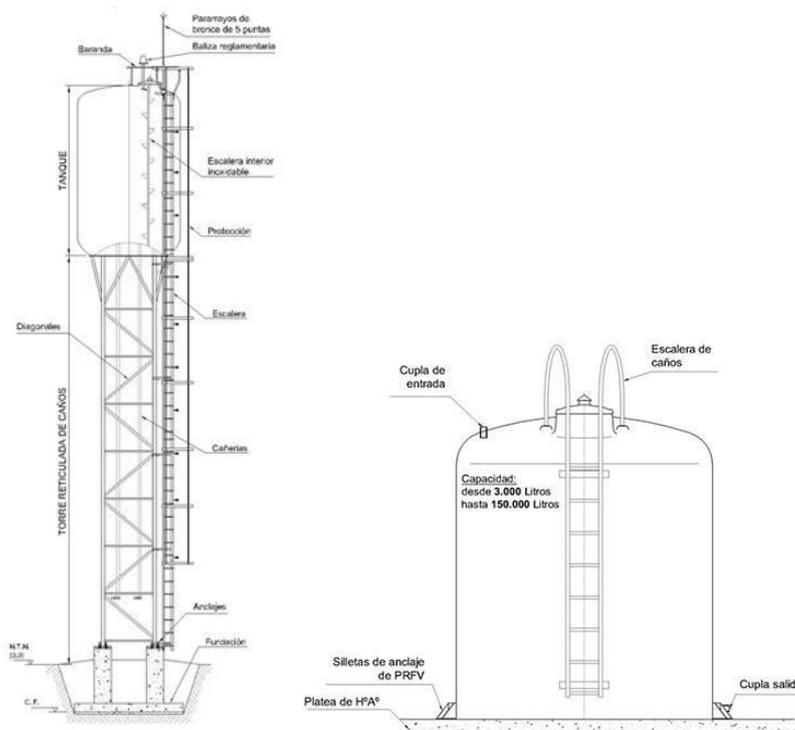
Izquierda: tanque de reserva. Derecha: tanque cisterna. Fuente: www.fimet.com.ar.
